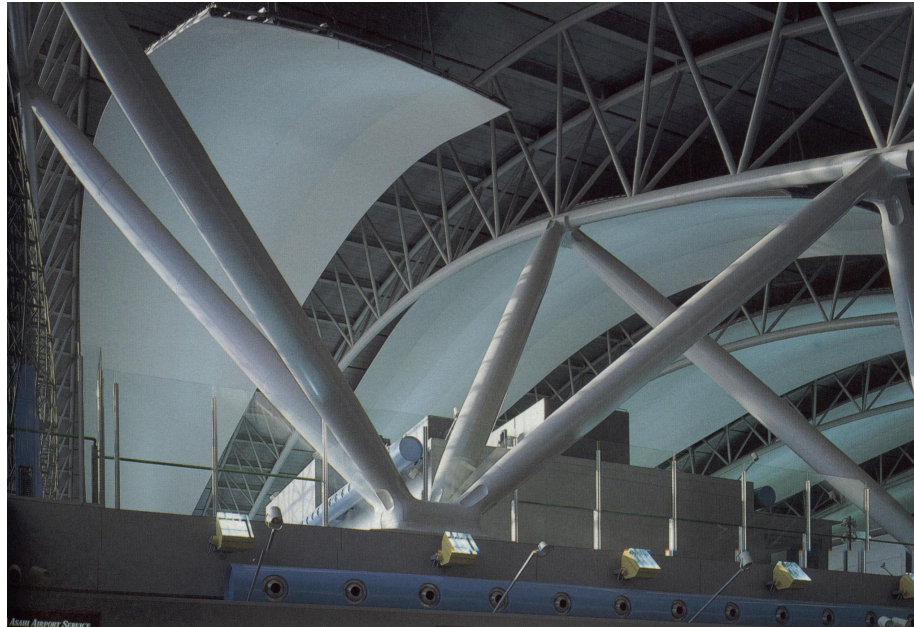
Aeroporto de Kansai: detalhe dos pilares da cobertura e do sistema treliçado
